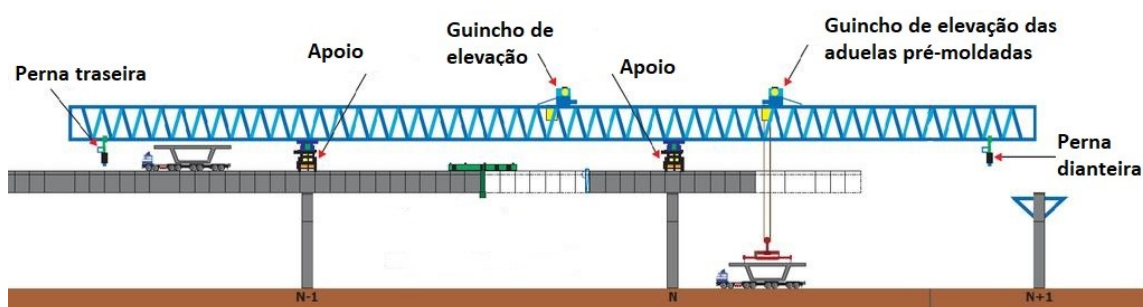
Instalação das aduelas utilizando equipamento de guindaste
